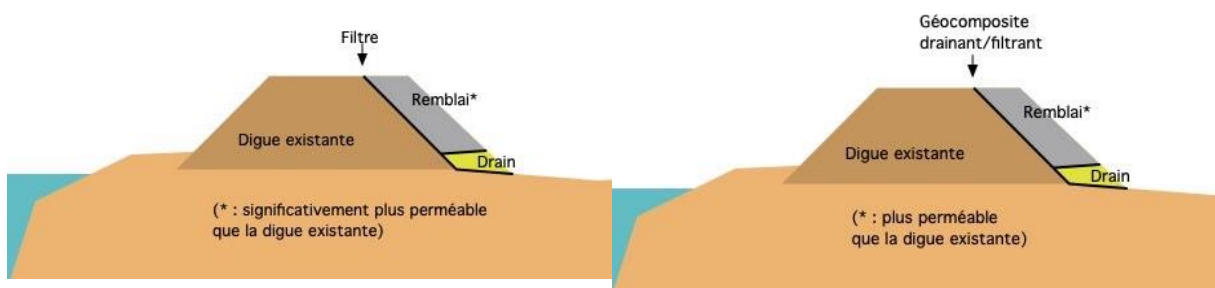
Drain de pied et filtres (schémas : R. Tourment)
